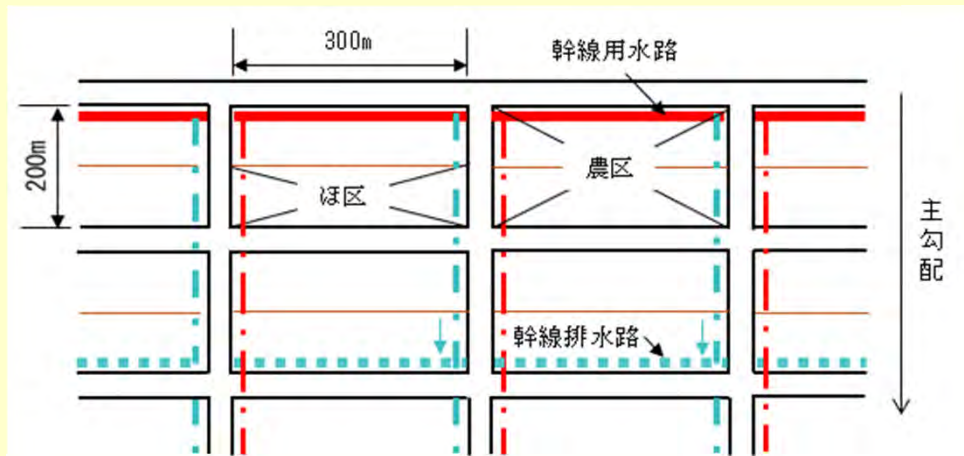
大区画化に向けた用排水路、農道の配置例
